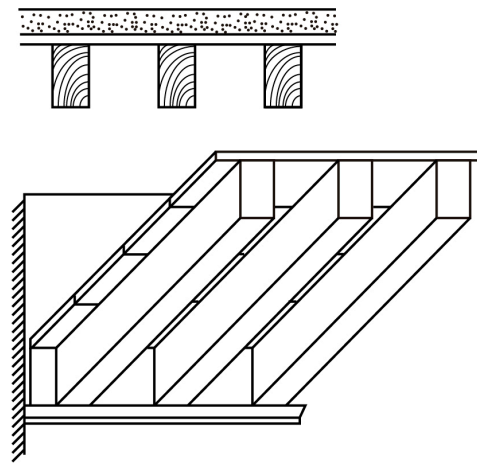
Axonometría y sección del entrepiso de viga y tablazón. Fuente: Elaboración propia.
